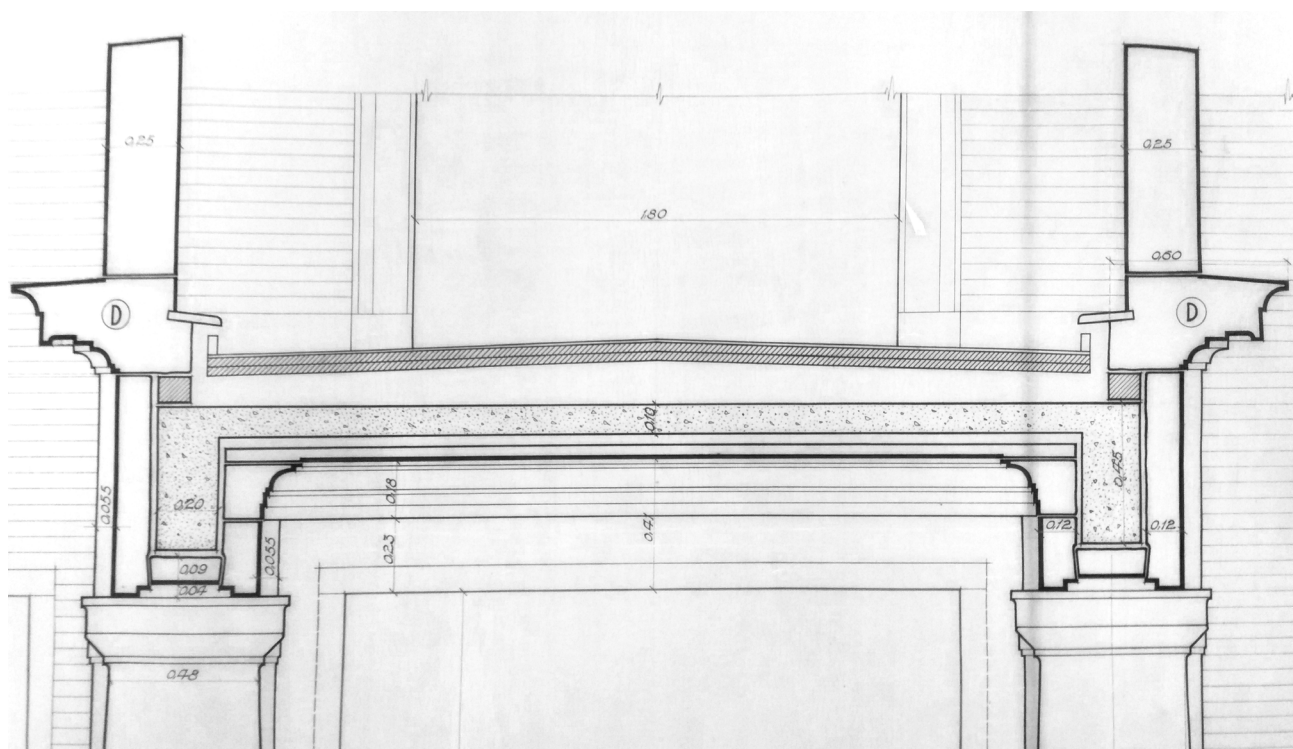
Facultad de Odontología. Detalle sección pórtico de acceso.
